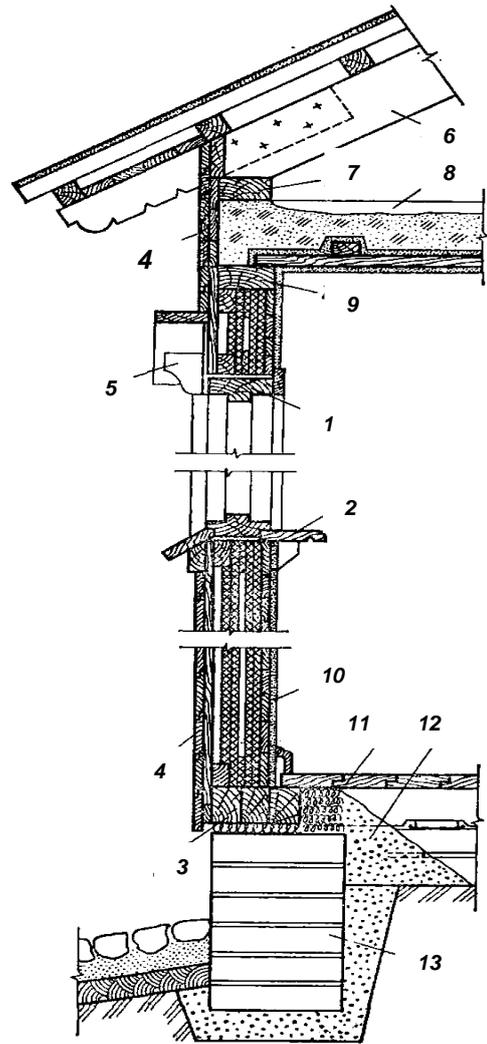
Конструкция щитового здания: 1 – оконная коробка; 2 – подоконная доска; 3 – нижняя обвязка; 4 – декоративная наружная обшивка; 5 – конструкция сандрика; 6 – стропильная нога; 7 – мауэрлат; 8 – балка перекрытия; 9 – верхняя обвязка; 10 – внутренняя отделка; 11 – эффективный утеплитель; 12 – шлак (керамзит); 13 – цоколь
